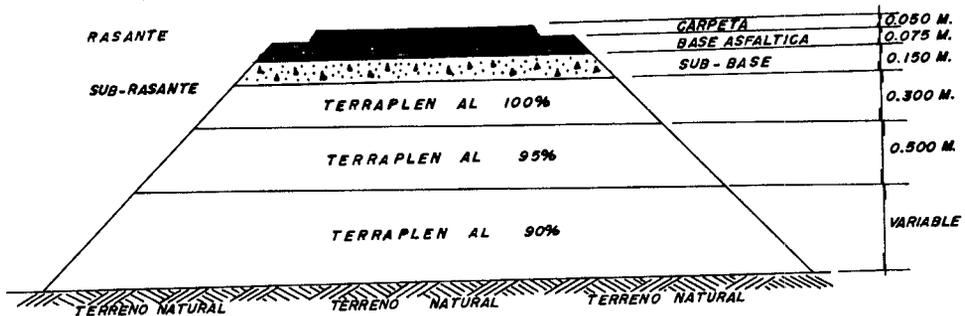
ELEMENTOS ESTRUCTURALES, TIPO.
